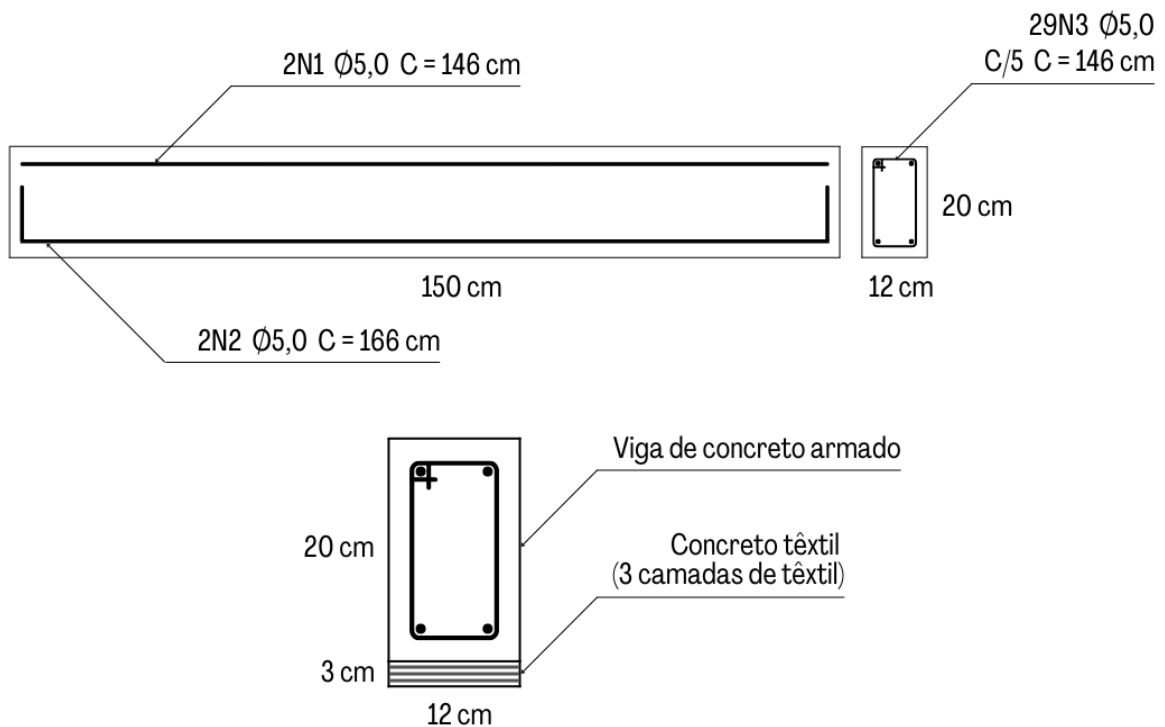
Configuração das vigas antes e depois do reforço (Fonte: Autor)
